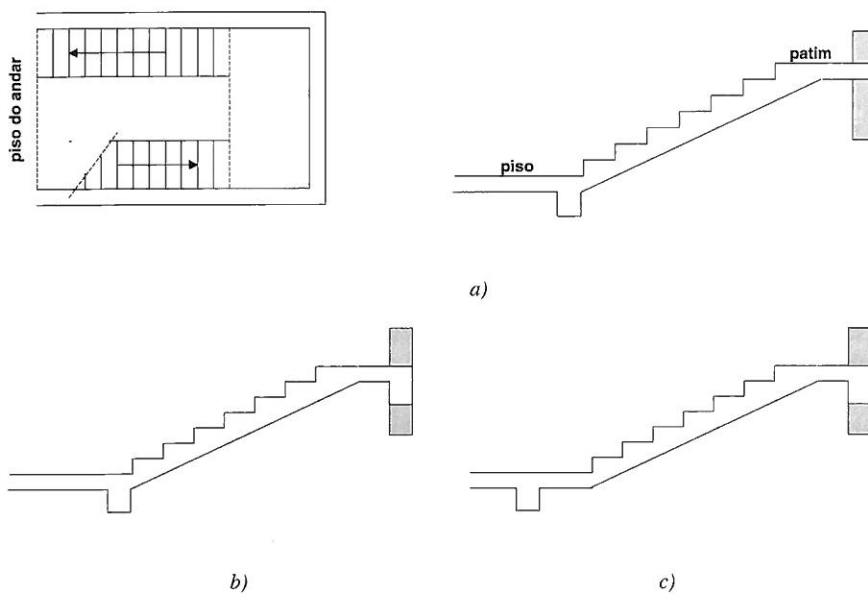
Tipos de escadas de lanços rectos apoiados nas vigas dos pavimentos
